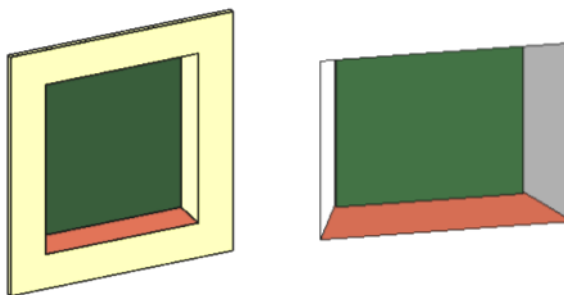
Traçado das feições da janela a partir da vista interna (ortofoto) e da planta baixa ("nuvem de pontos")
